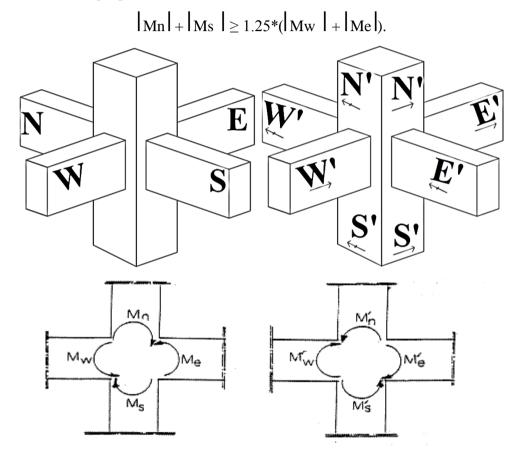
Dimensionnement des nœuds poteaux-poutres
